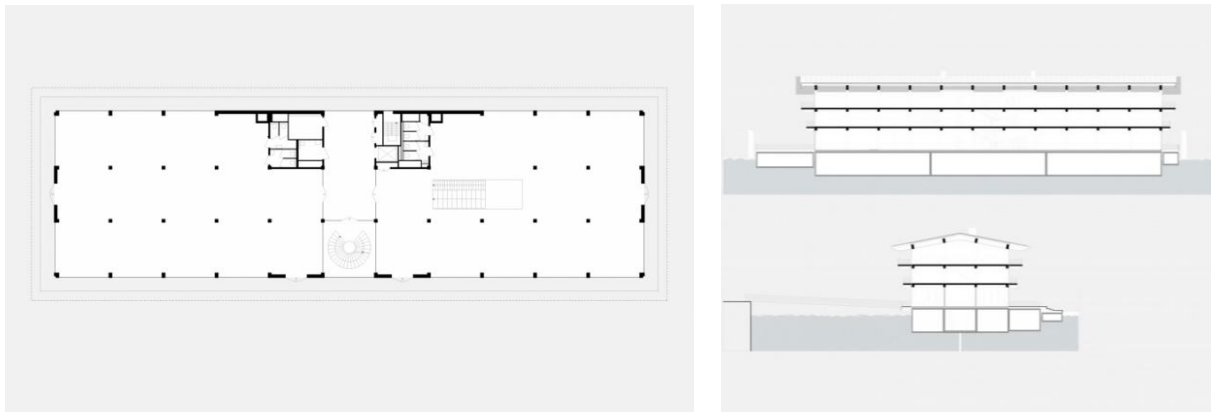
, рис. 2.20. План першого поверху, розрізи, Powerhouse company, 2021, Роттердам, Нідерланди [28]
